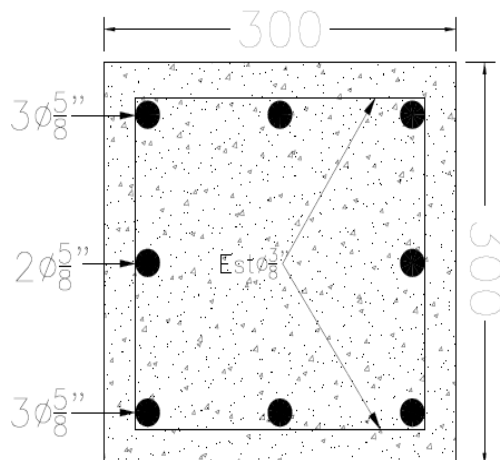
Corte transversal refuerzo de columna. (Fuente: Elaboración propia)
